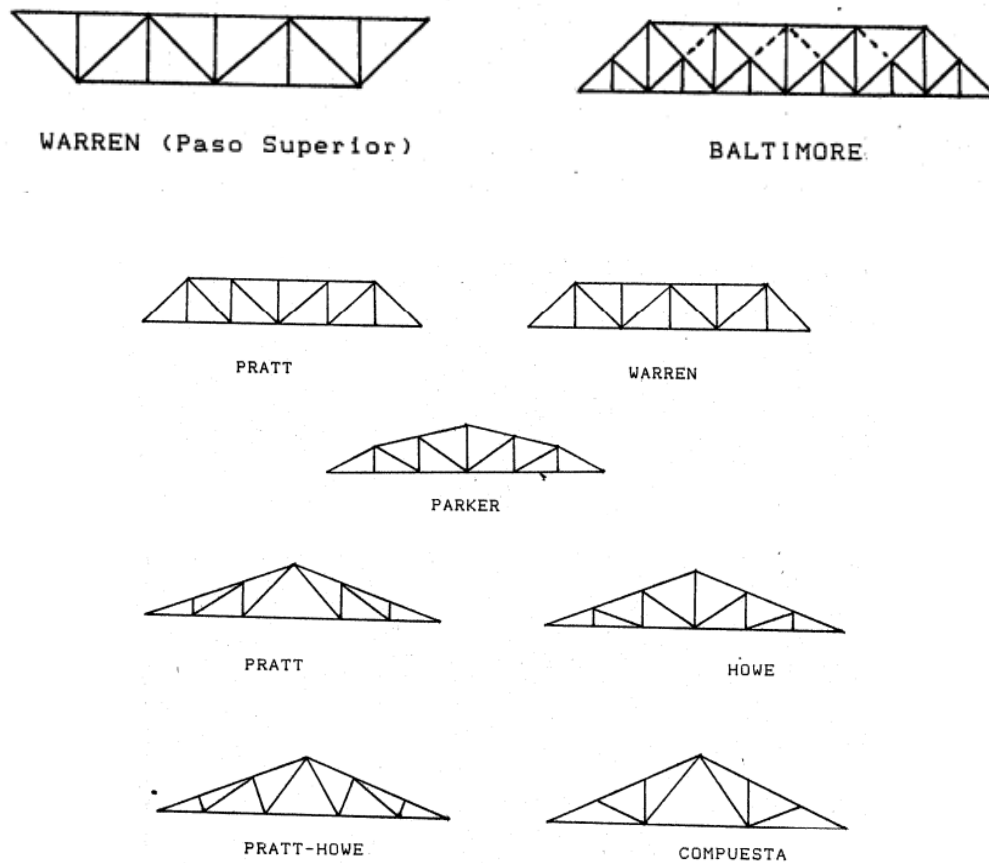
Tipos de armaduras (Fuente McCormac y Nelson; 2002; 478)
